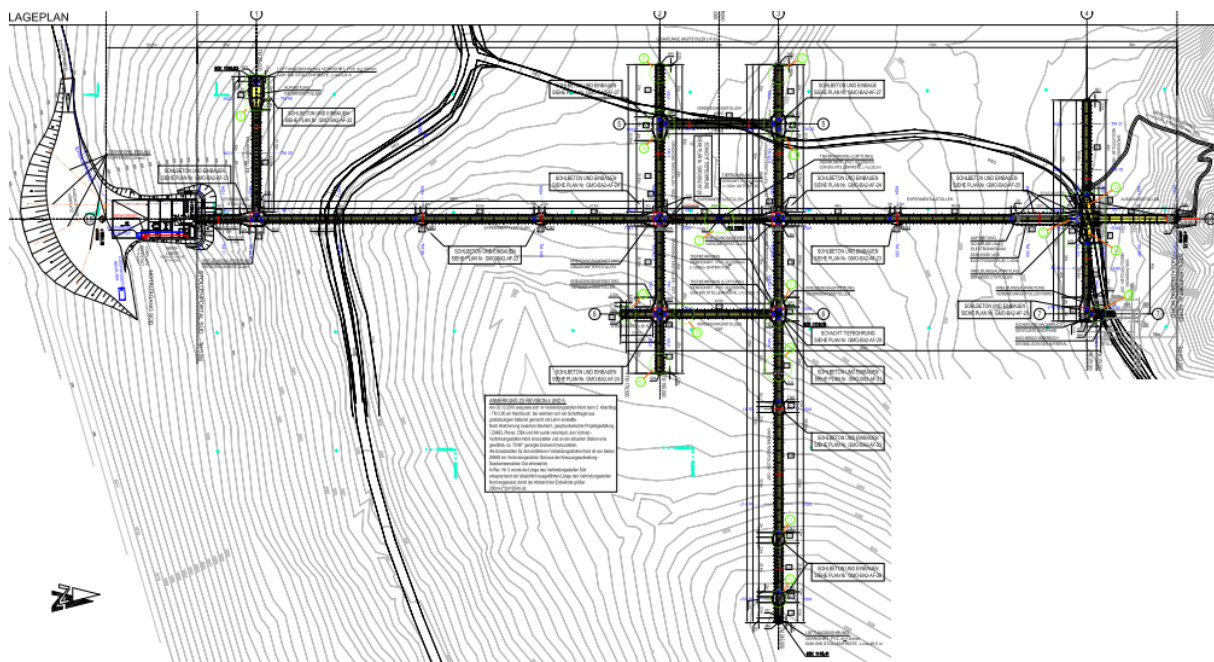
Grundriss ohne Maßstab, Stollenanlage Conrad Observatorium 2. Baustufe
